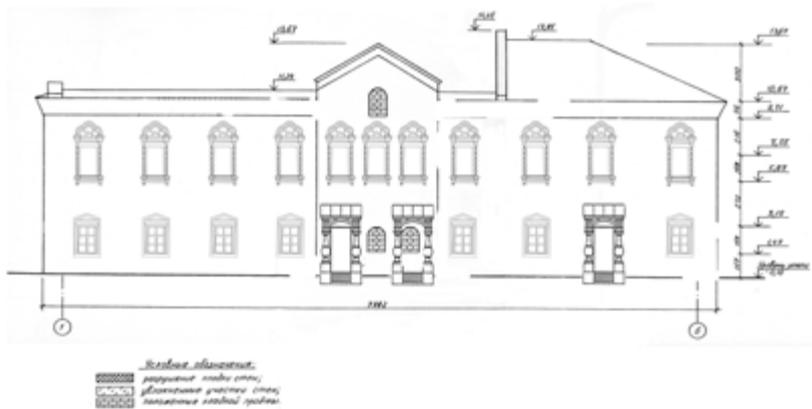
Реконструкция плана фасада здания трапезной. 1907 г.<sup>1</sup>
